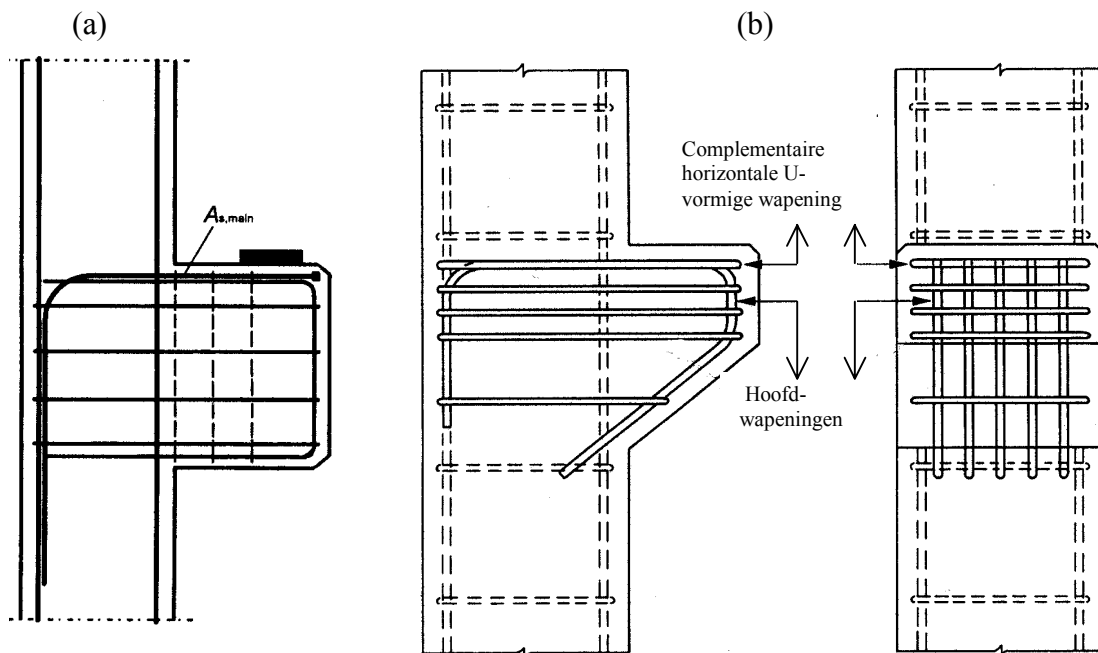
Voorbeelden voor de verankering van de hoofdwapening van consoles
